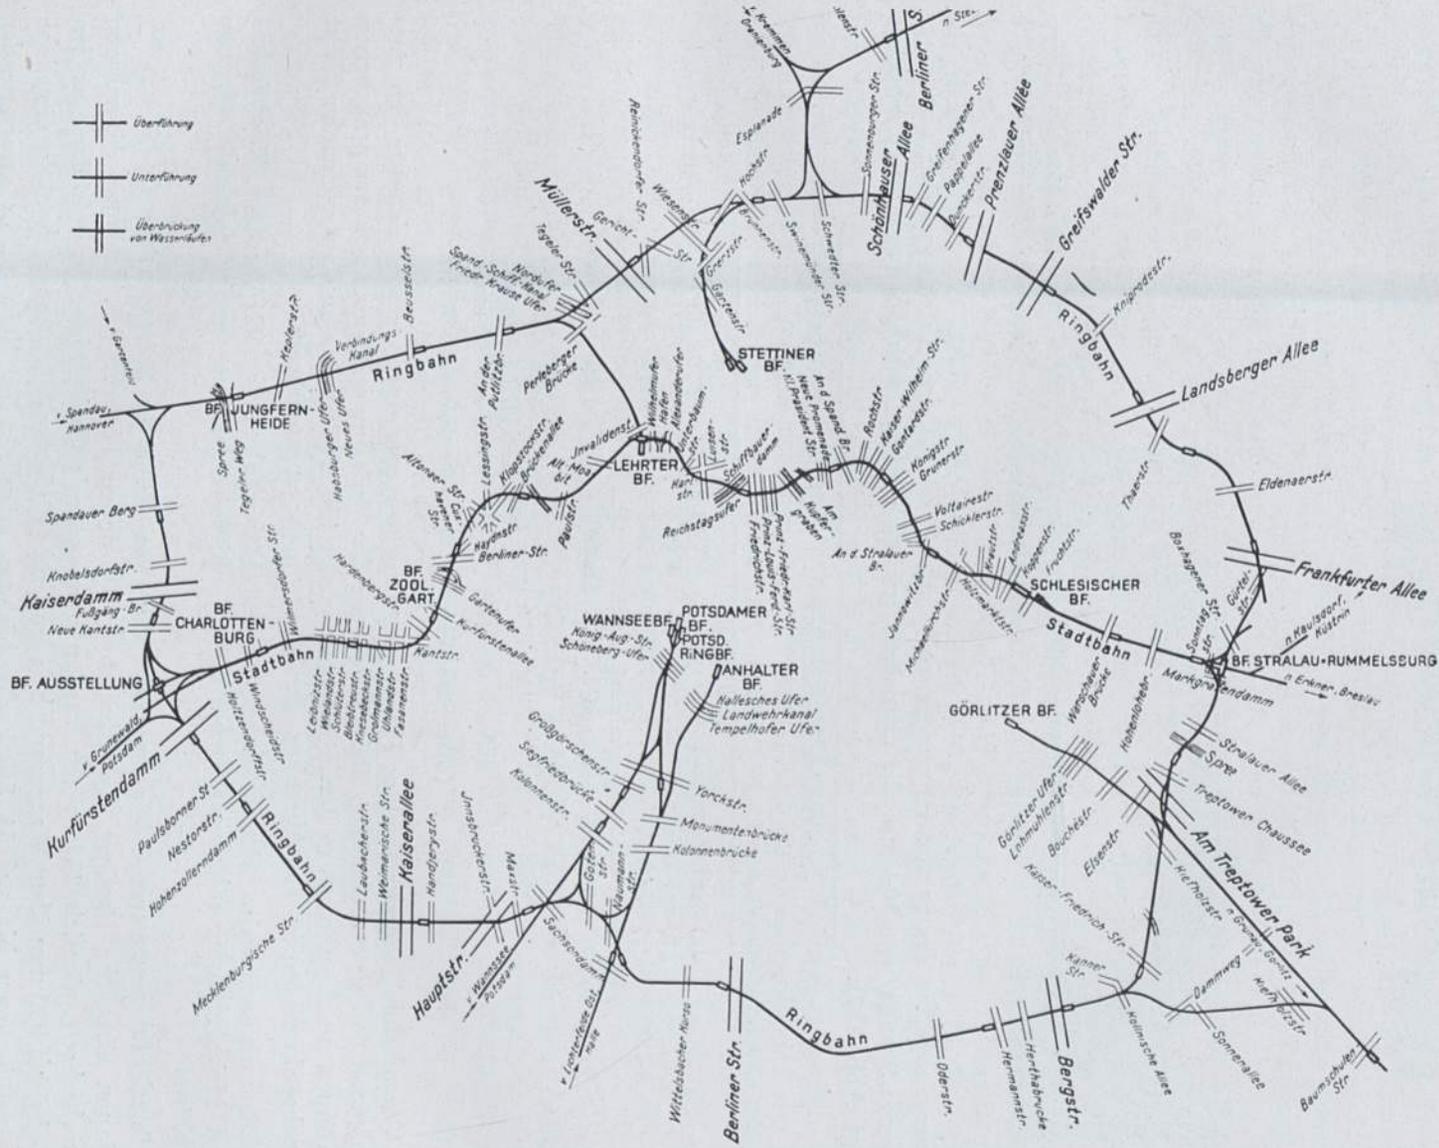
Übersichtsplan der Berliner S- und Fernbahnunter- und -überführungen.
